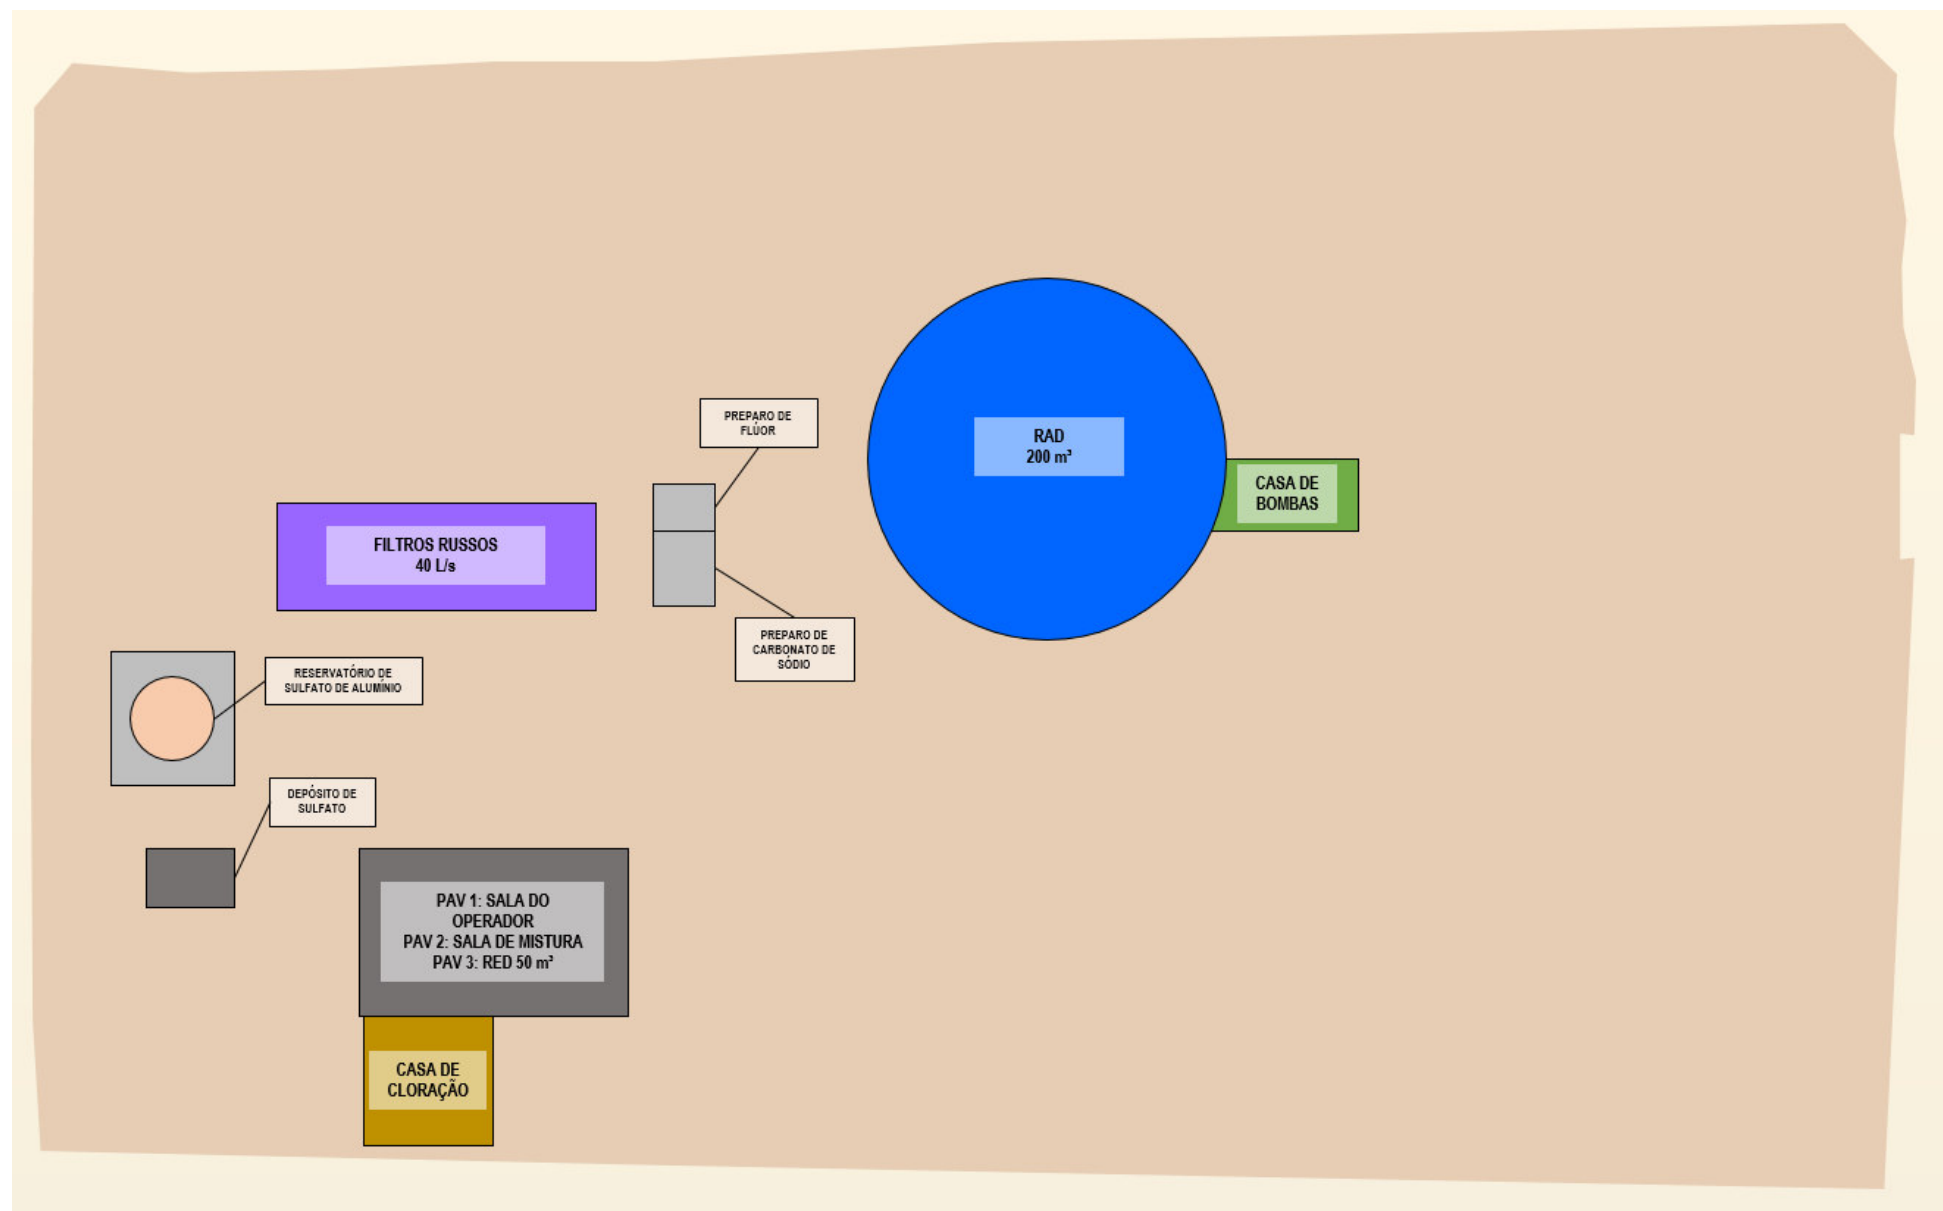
Croqui Esquemático do Layout da ETA de Saubara
